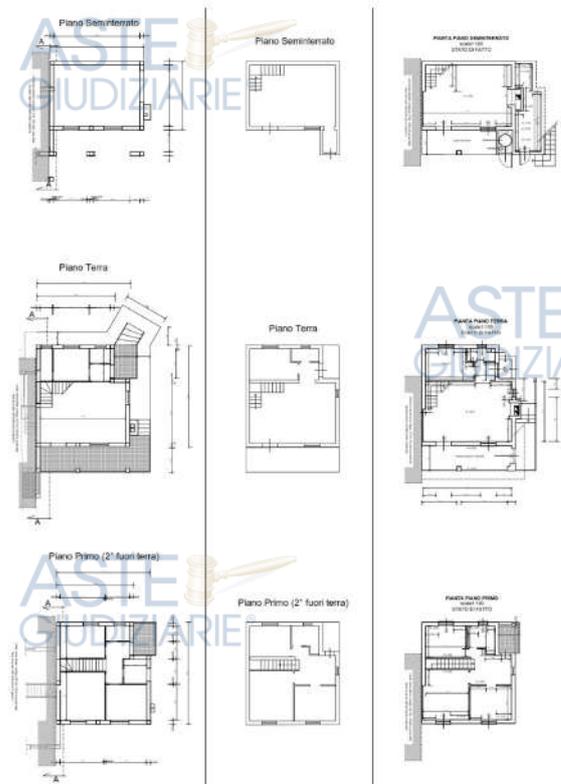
Quadro sinottico di raffronto, estratto dall'All.12.
